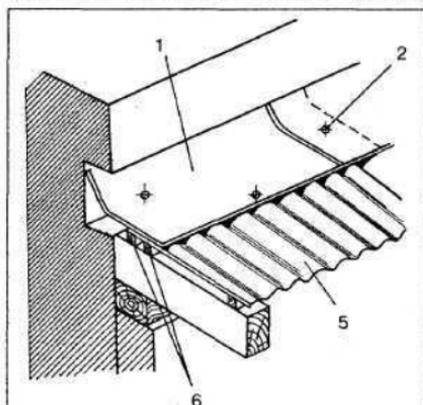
Поперечное примыкание ската шиферной кровли к стене:
